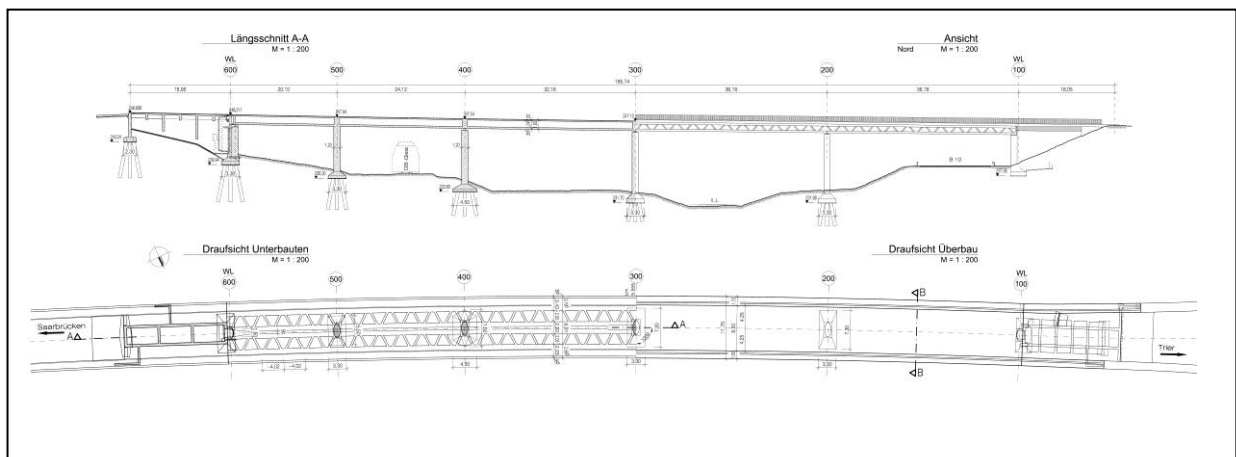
Vue / Coupe et plan de l'ouvrage 334 ouvrage partiel 2
